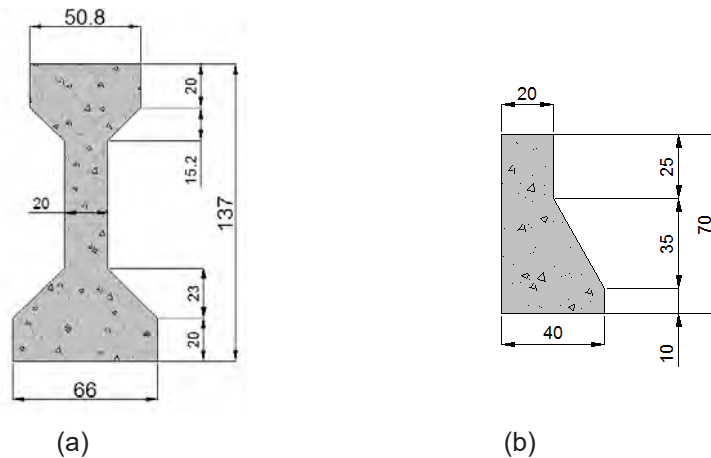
Geometría de: a) viga AASHTO tipo IV, b) parapeto, acotada en centímetros.
